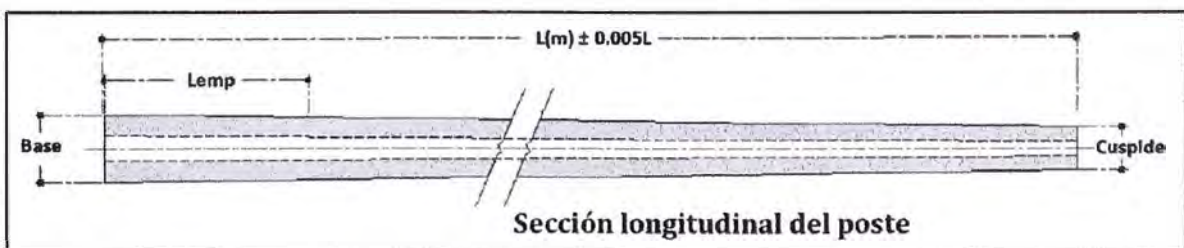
Vista de perfil de poste de concreto armado centrifugado
